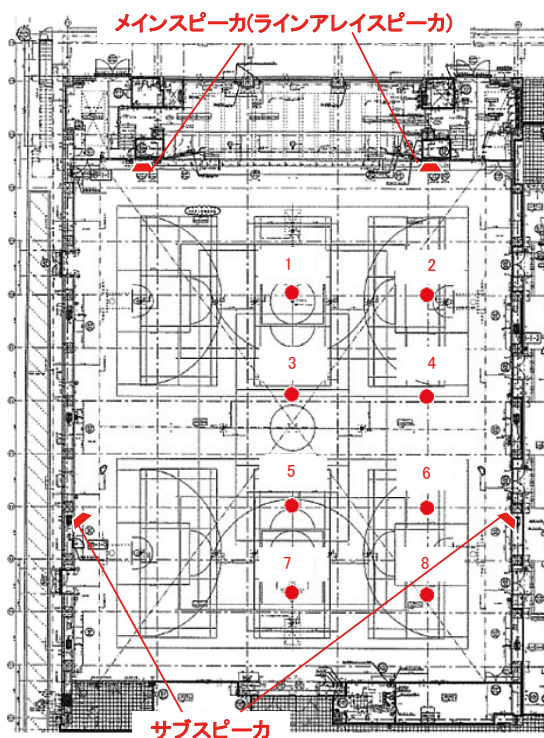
D 大学講堂兼体育館 平面図、スピーカおよび測定点位置
